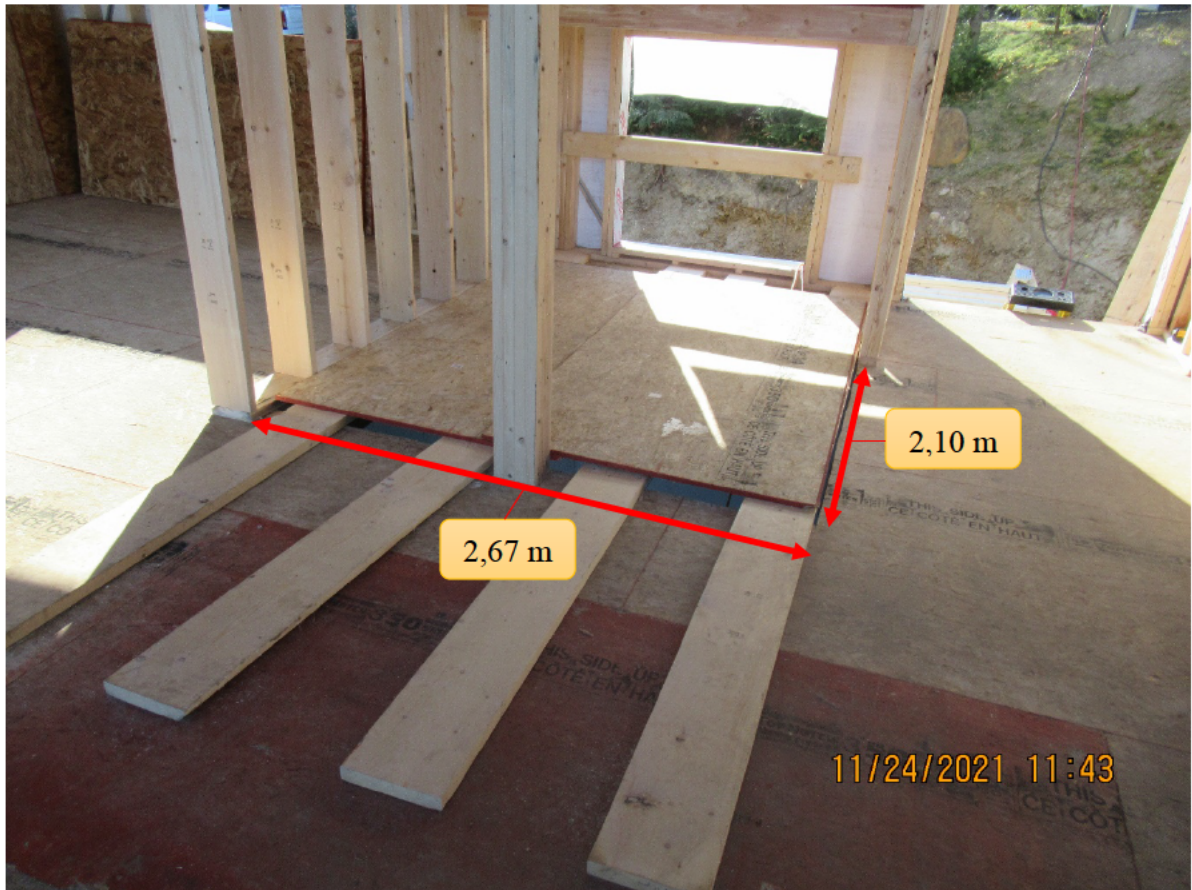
Ouverture pour la cage d'escalier au rez-de-chaussée
